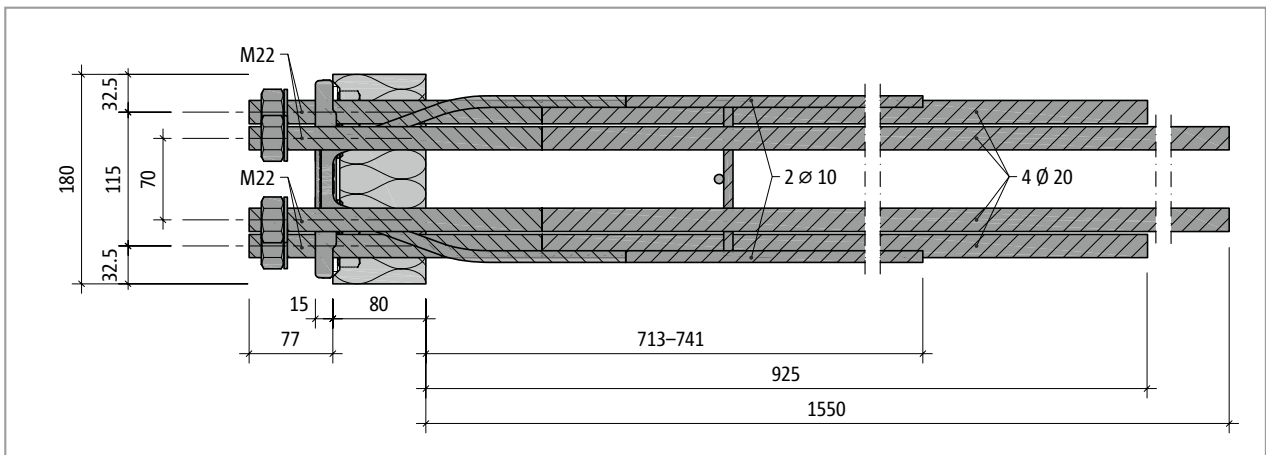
Schöck Isokorb® T type SK-MM2-VV1: Plan view
